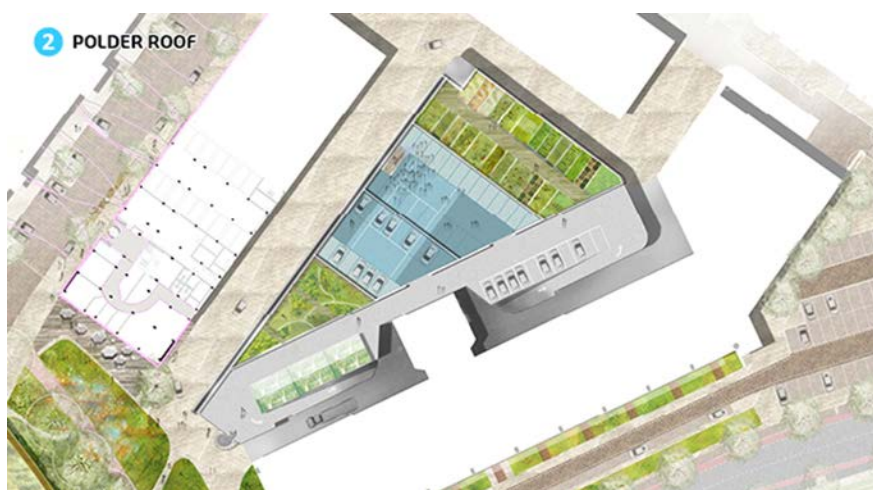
| Climate Proof Zomerhofkwartier: progetto pilota Polder Roof.
